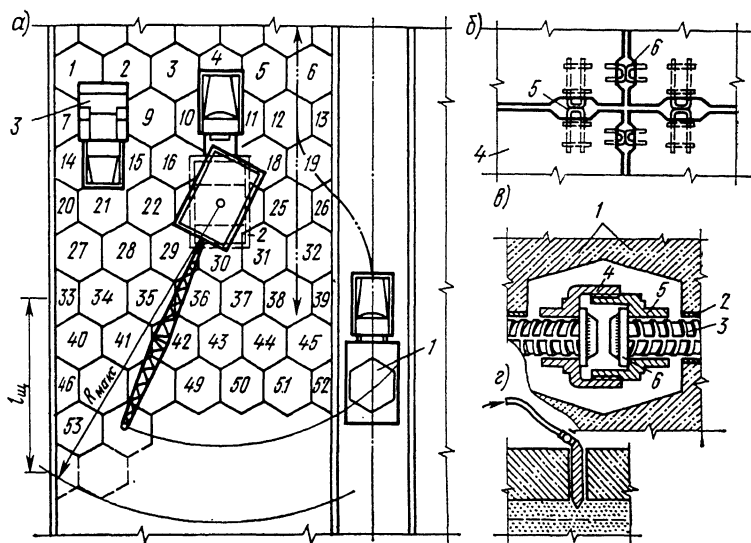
Монтаж покрытия городской улицы из сборных железобетонных плит
